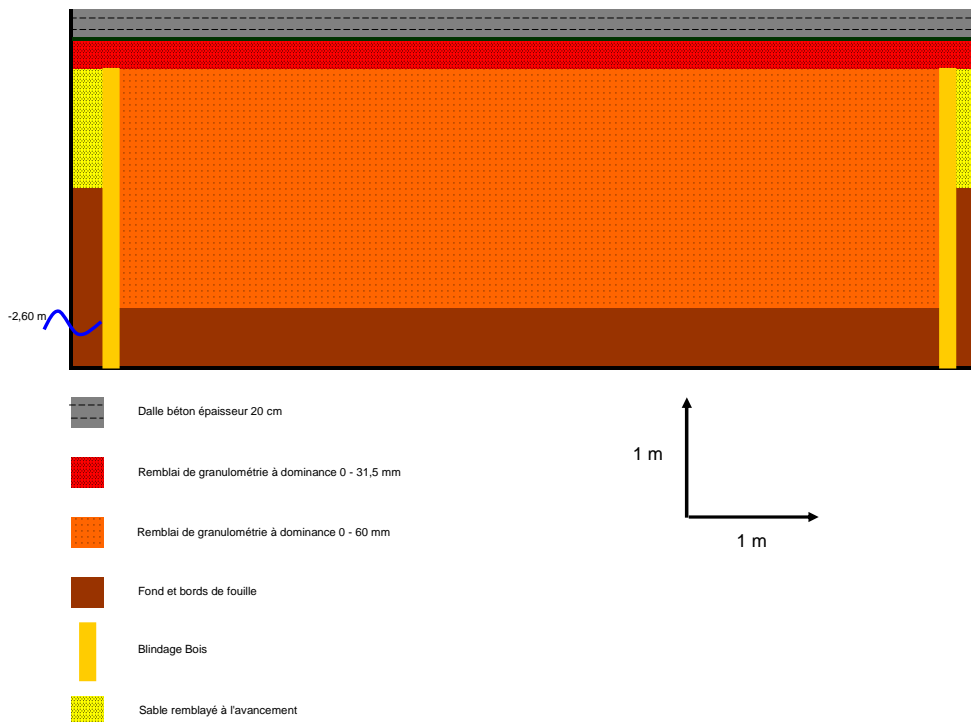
Vue en coupe du sous sol au droit de la zone de travaux
